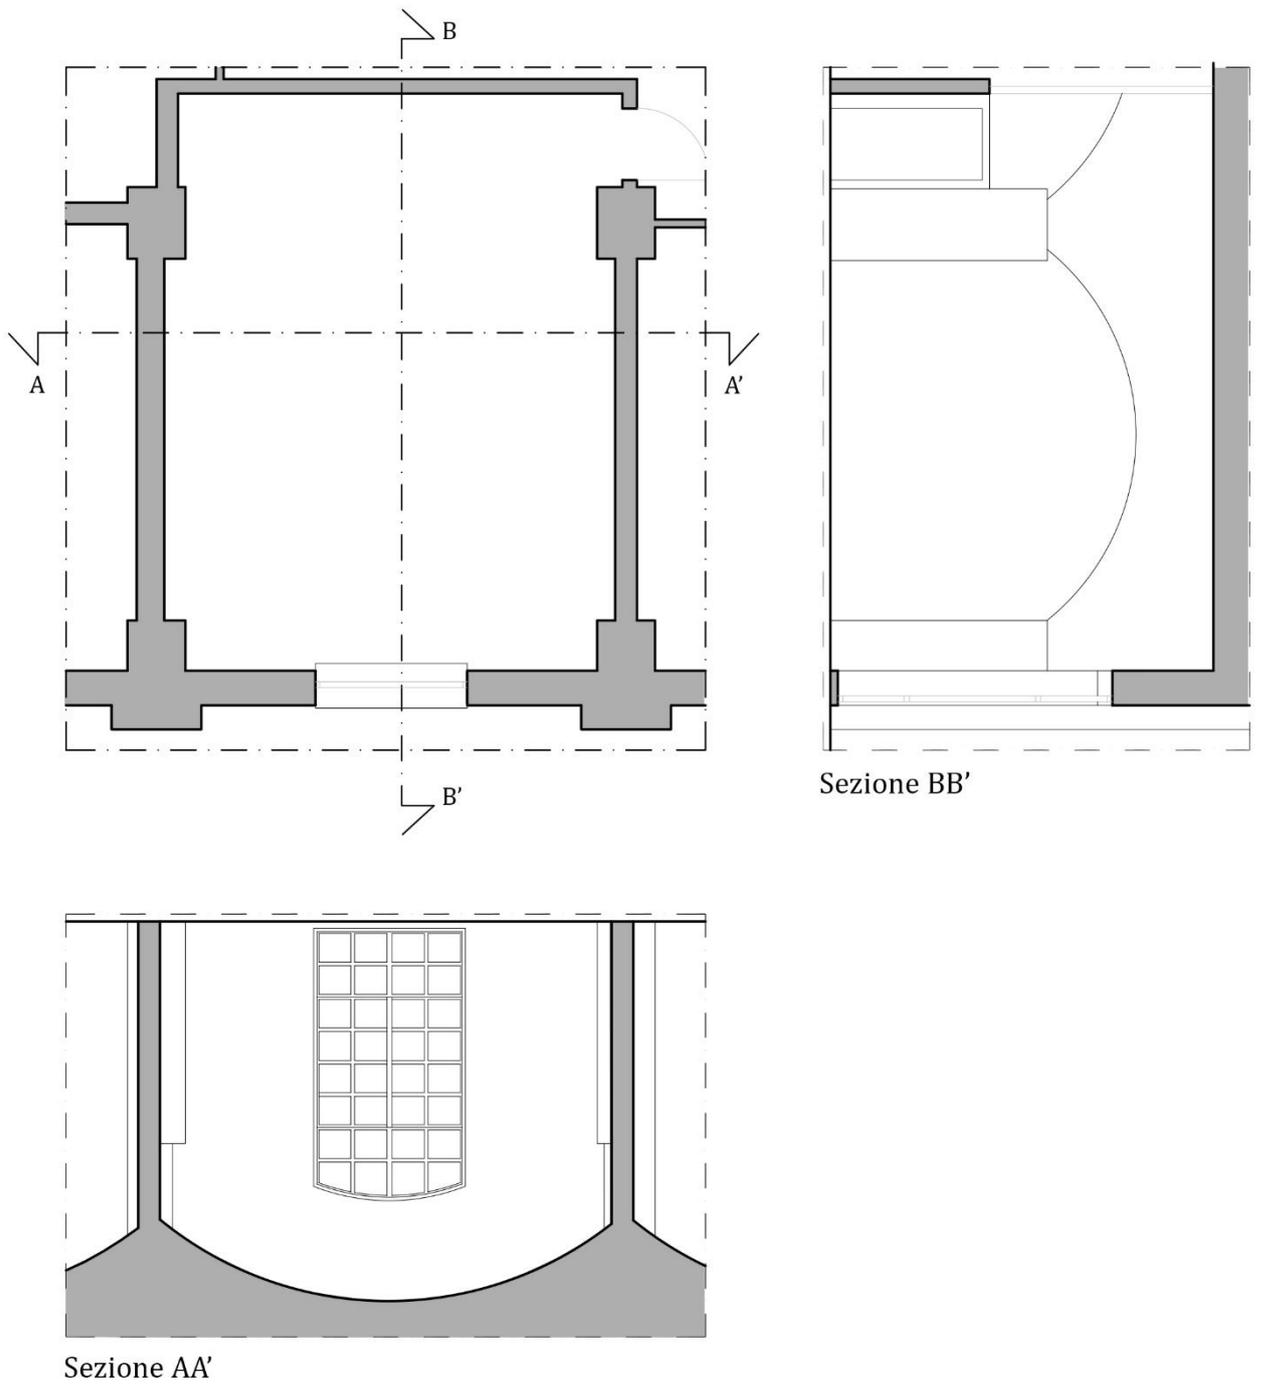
Pianta e sezioni in scala 1:100 dell'aula con esposizione a sud-ovest situata al piano terra.
